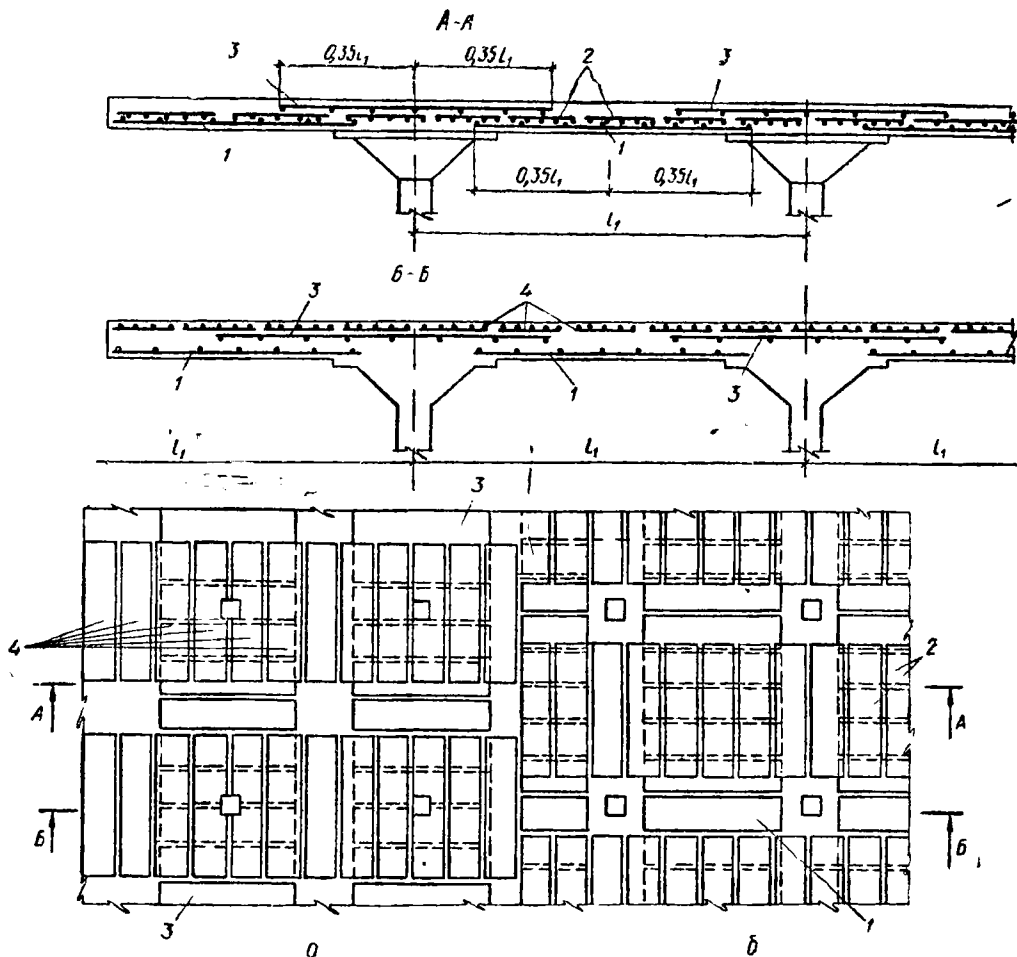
Армування монолітного безбалкового перекриття вузькими сітками:
